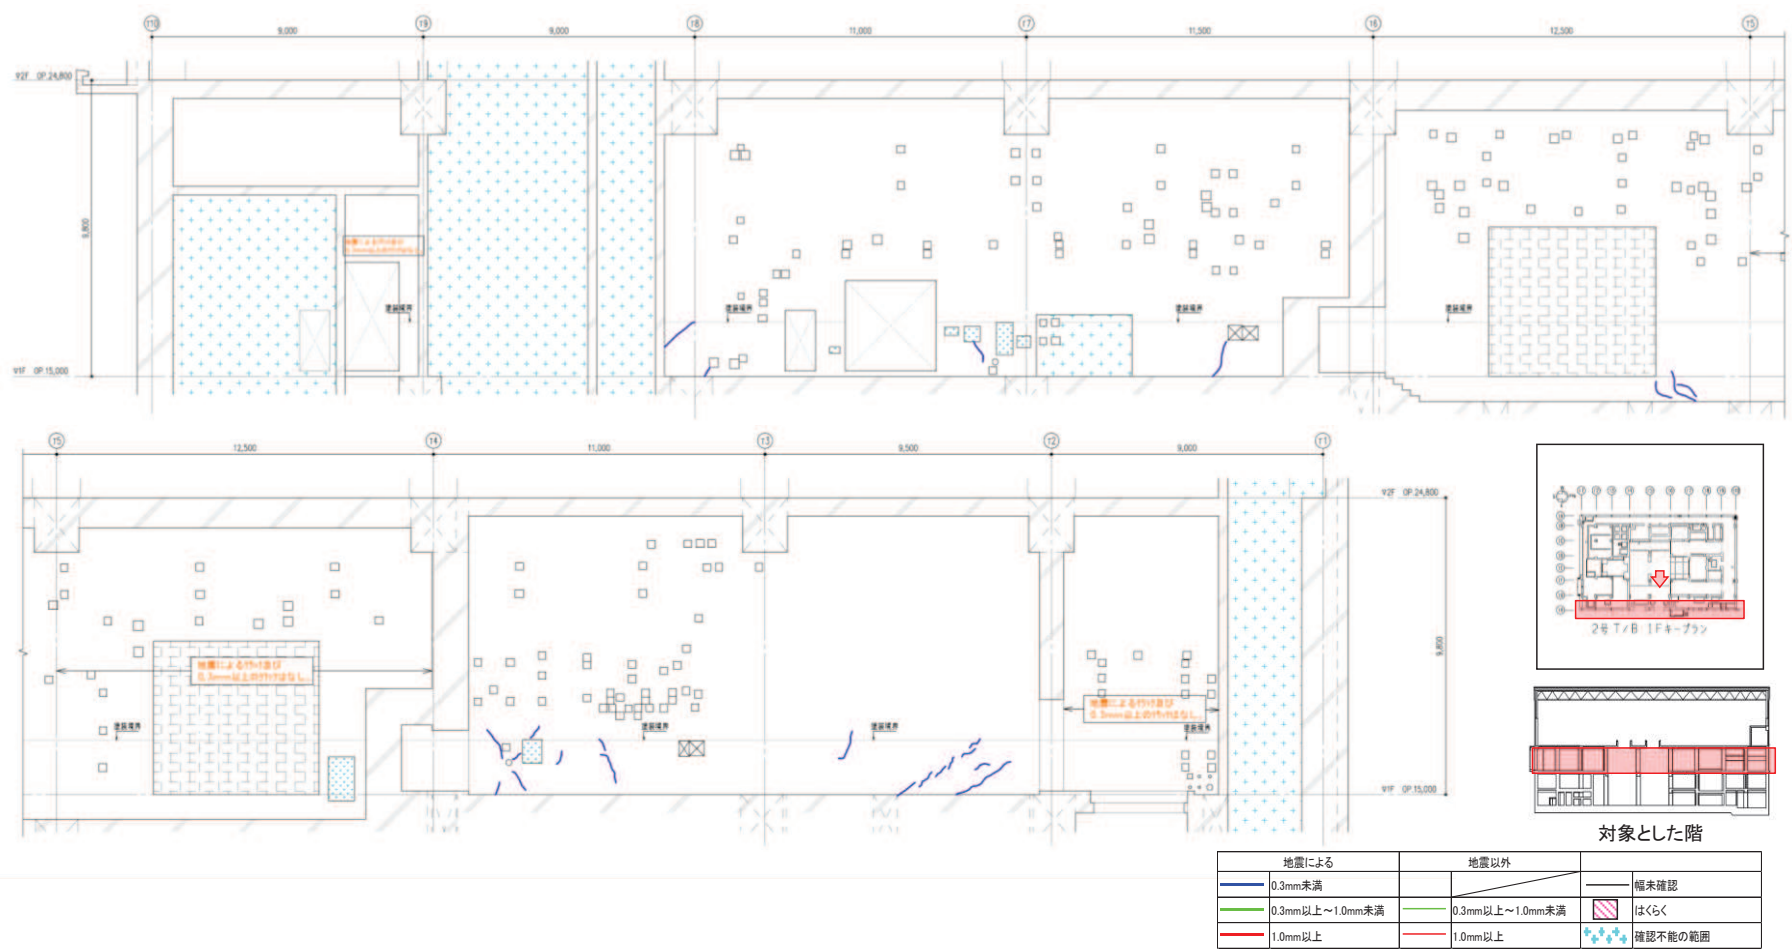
タービン建屋のひび割れ分布 耐震壁 (48) 1階 TH 通り
